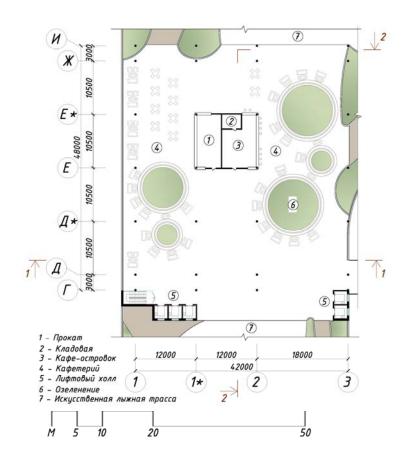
Рекреационный центр. План 4-го этажа – крытая терраса
